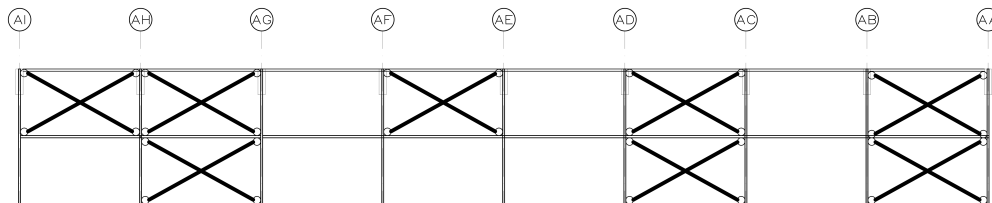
Elementos con plastificaciones longitudinales en arriostres
